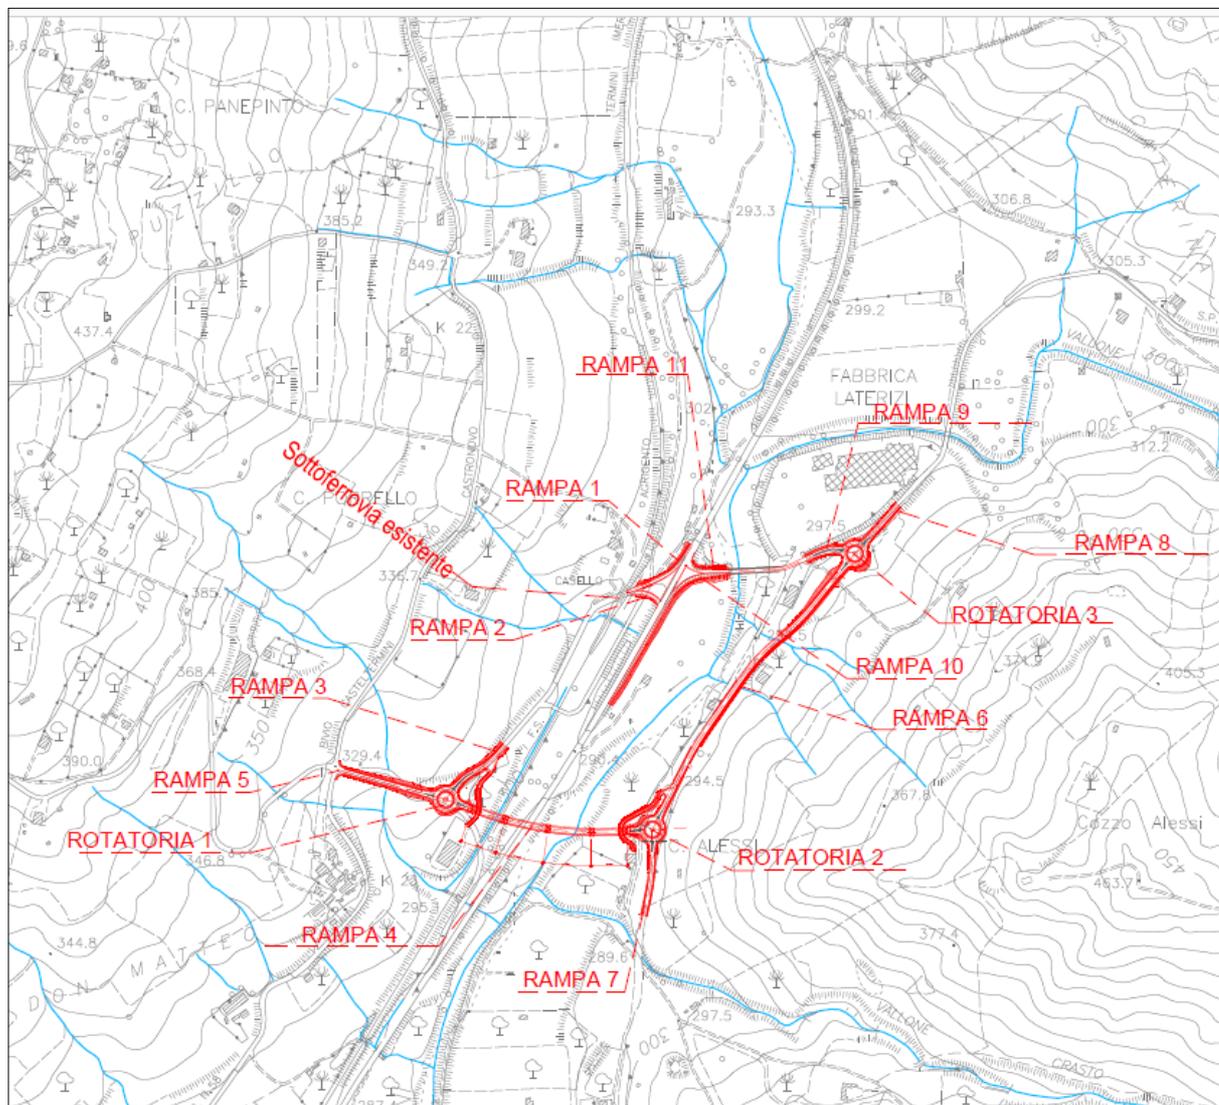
Schema degli interventi stradali previsti su stralcio CTR
